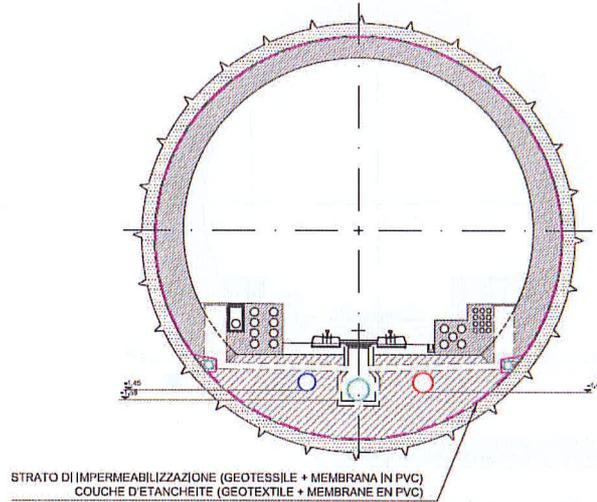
Impermeabilizzazione di tipo 5/5a per scavo con TBM aperta
